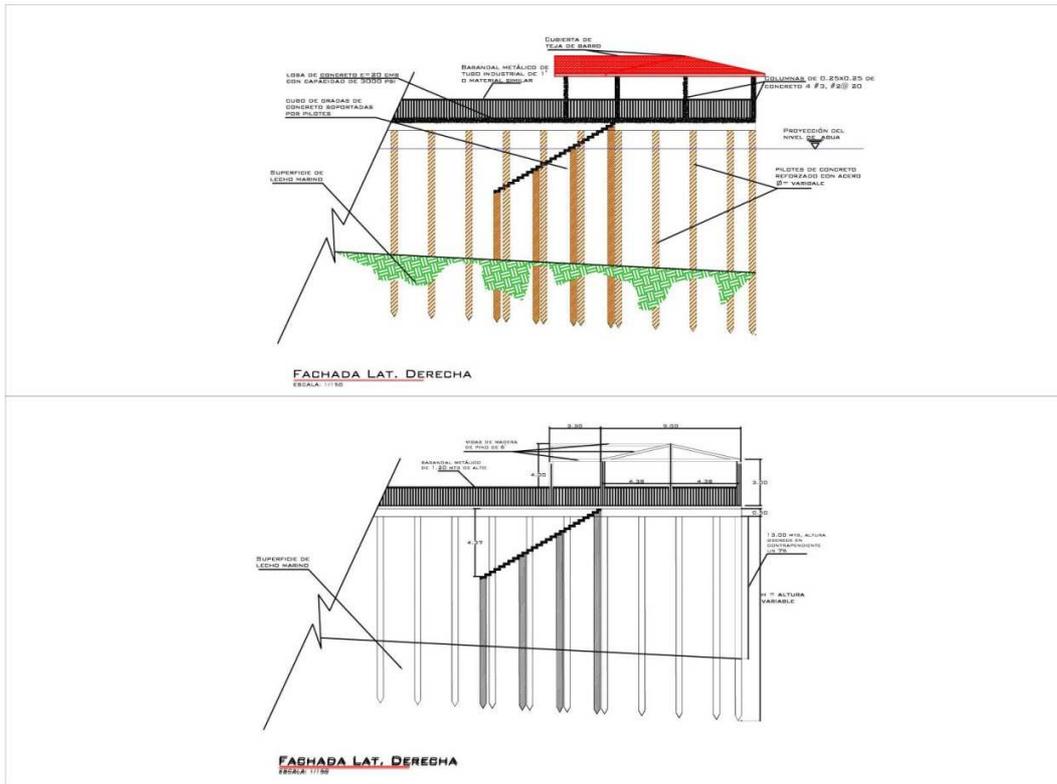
Fachada lateral con propuesta de muelle con pilotes.
